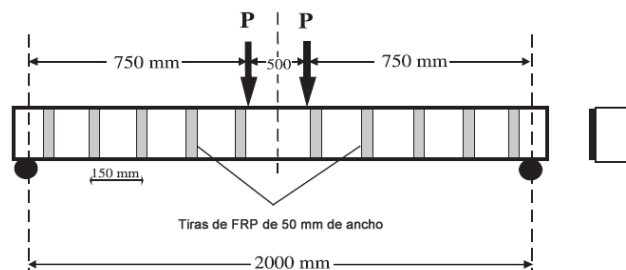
Diagrama esquemático del espécimen reforzado usando tiras verticales de CFRP
